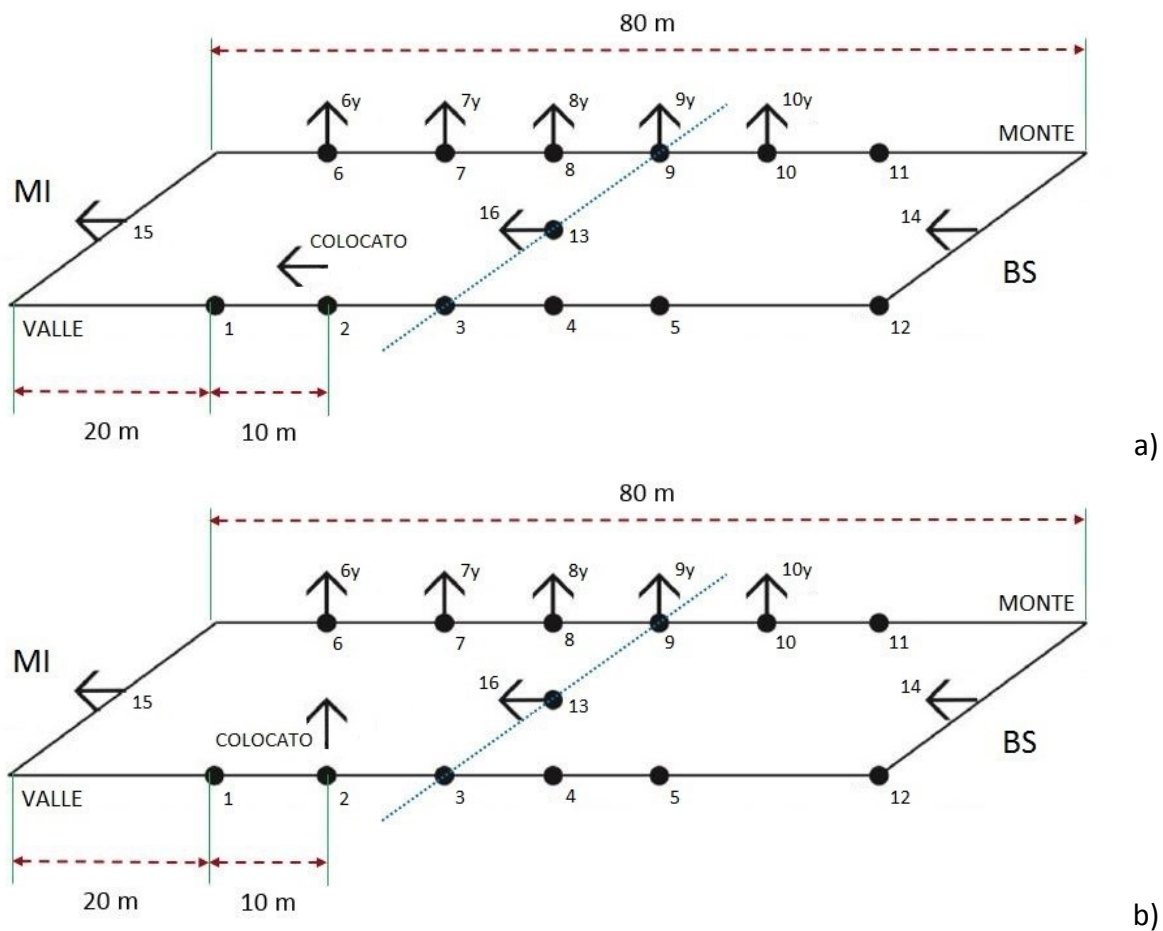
schema posizione sensori prova con forzamento orizzontale; a) longitudinale; b) trasversale.
